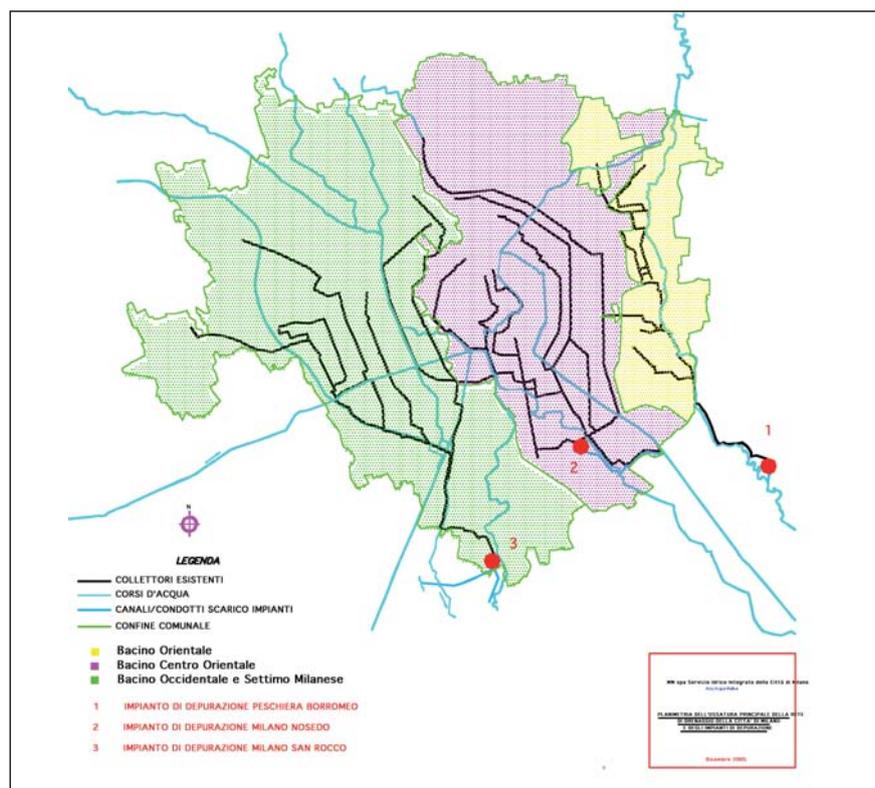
Planimetria ossatura principale rete e impianti di depurazione
